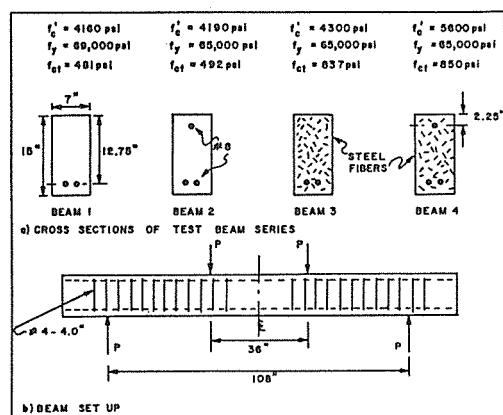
(a) Cross sections and beam arrangement for flexural tests on reinforced fiber concrete.
